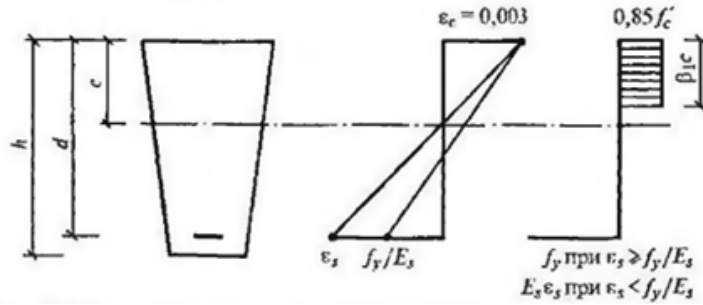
Расчетная схема нормального сечения железобетонного элемента
